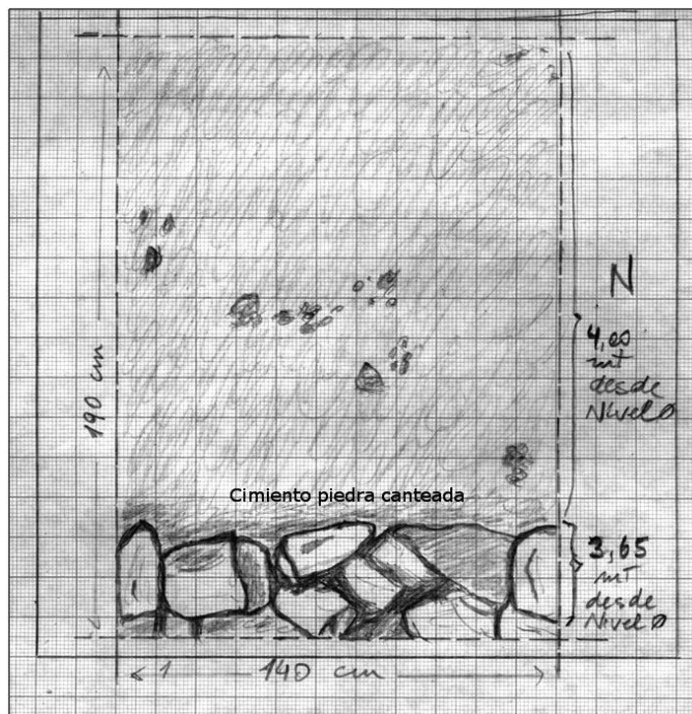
Dibujo en planta del cimientto de bloques canteados, entre 365 cm y 400 cm de profundidad, posiblemente incaico. Pila D2 1. Cripta de los Obispos, Catedral Metropolitana. Imagen extraída de Rivas (2005)
